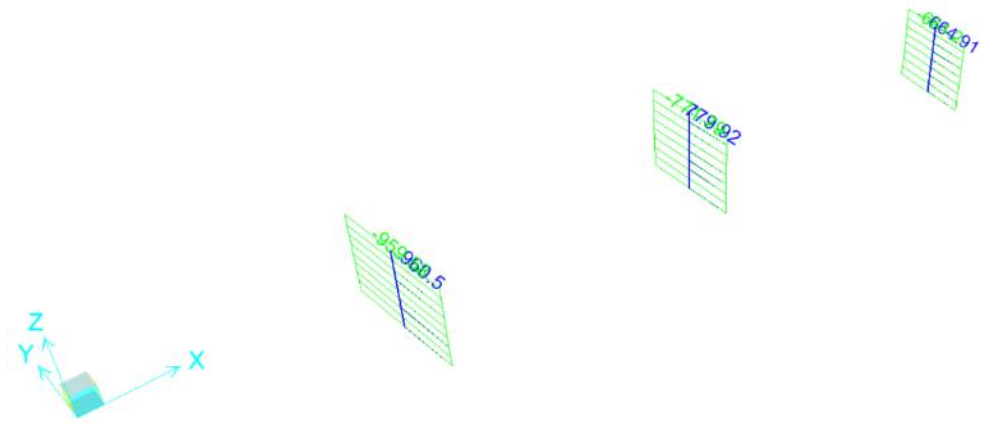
Diagrama cortante transversal (KN) de las columnas puente Vía a Minca
